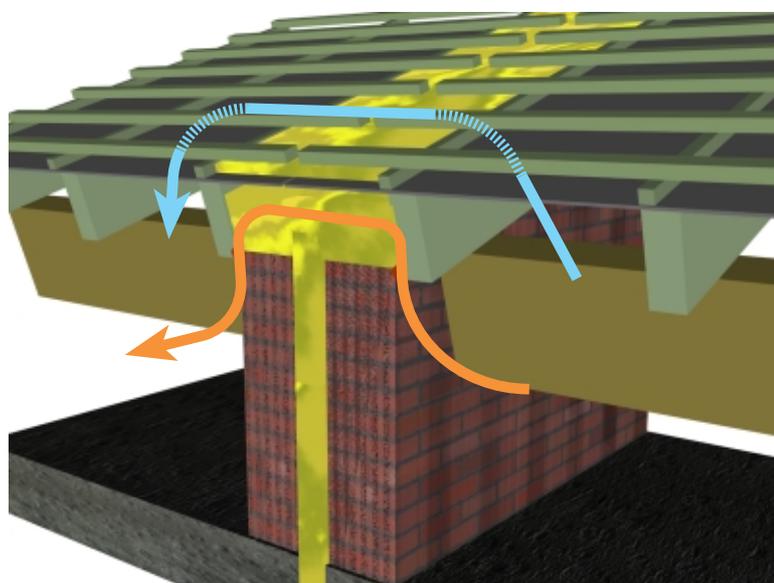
Détail de la jonction avec une toiture à versants : chevrons posés contre les parois du mur mitoyen, colmatage des points de fuite acoustique. Si des vides subsistent entre les panneaux de sous-toiture et les parois du mur mitoyen, il convient d'appliquer de la laine minérale entre les deux chevrons. Cette mesure devrait prévenir, le cas échéant, la propagation du bruit "dérivé" (flèche rouge).
